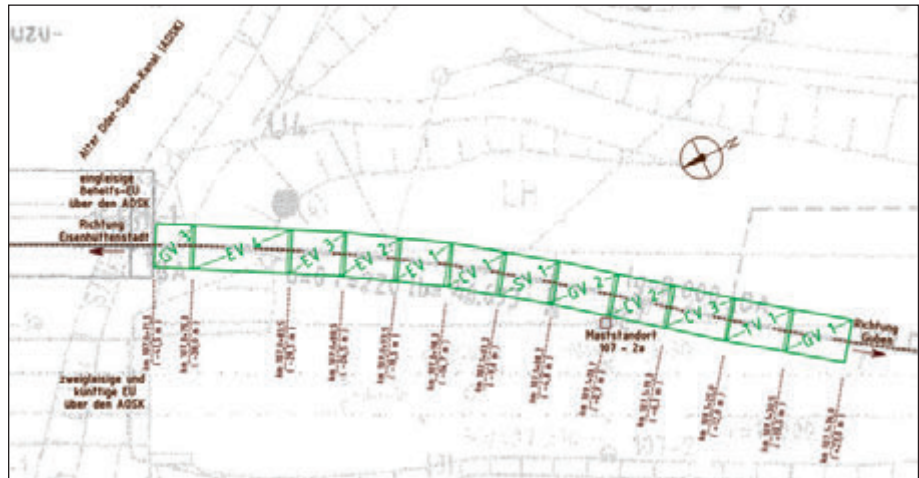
Lageplan des Versuchsabschnitts im Großversuch Eisenhüttenstadt mit Darstellung der eingebauten 12 unterschiedlichen Geokunststoffproben
